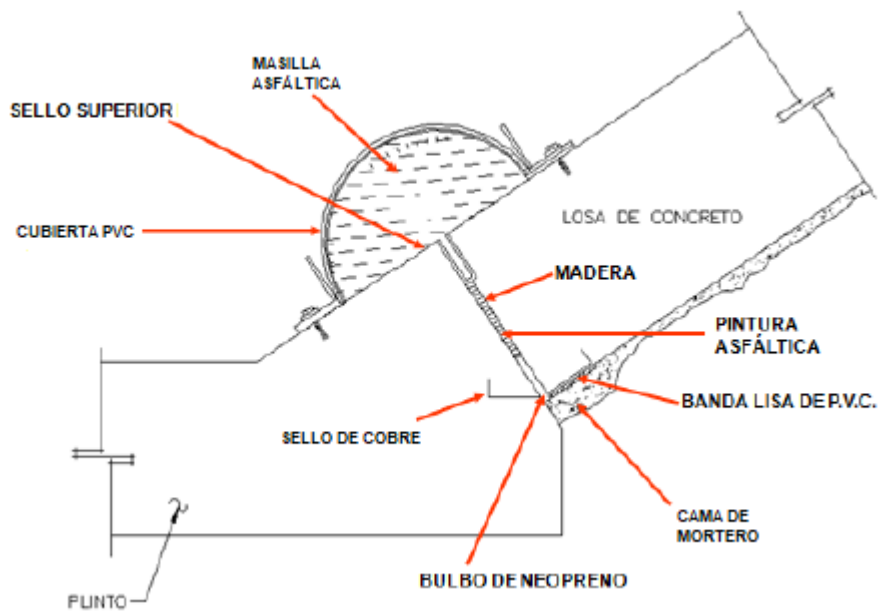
Detalle sello junta perimetral; Fuente: Construcción de cortina de enrocamiento P.H La Yesca
